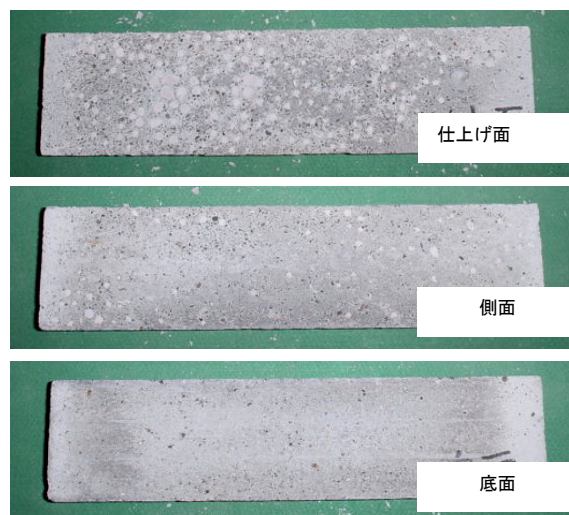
凍結融解試験後の供試体の状況 (No. 38)
